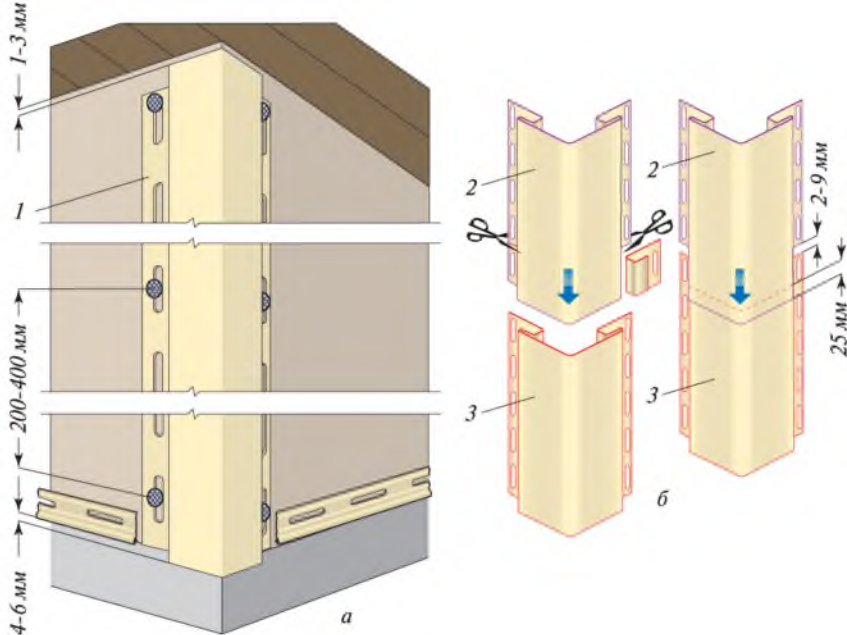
Монтаж наружного углового профиля: а — общий вид; б — стыкование угловых профилей внахлест; 1 — наружный угловой профиль; 2 — верхний профиль; 3 — нижний профиль
